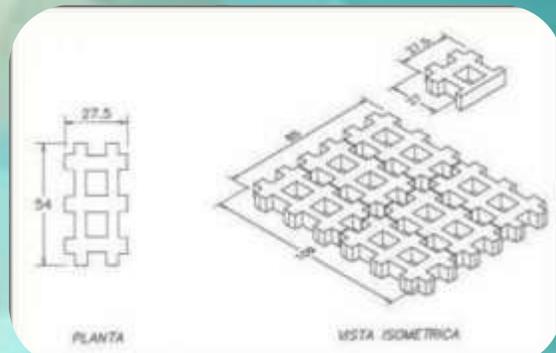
Colocación de adopasto. Imagen 61. Dimensiones del adopasto.
